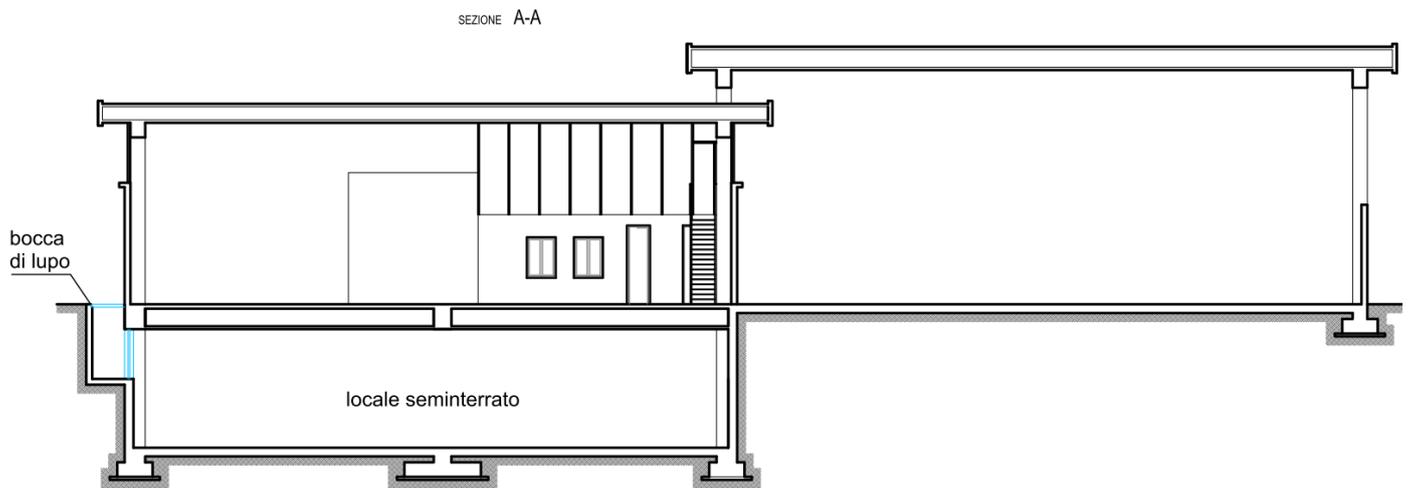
SEZIONE DEL PIANO INTERRATO CON IDICAZIONE DELLE BOCHE DI LUPO.
